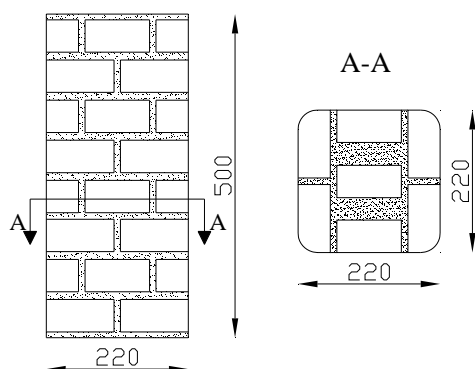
Disposizione degli elementi in tufo nel pilastrino
